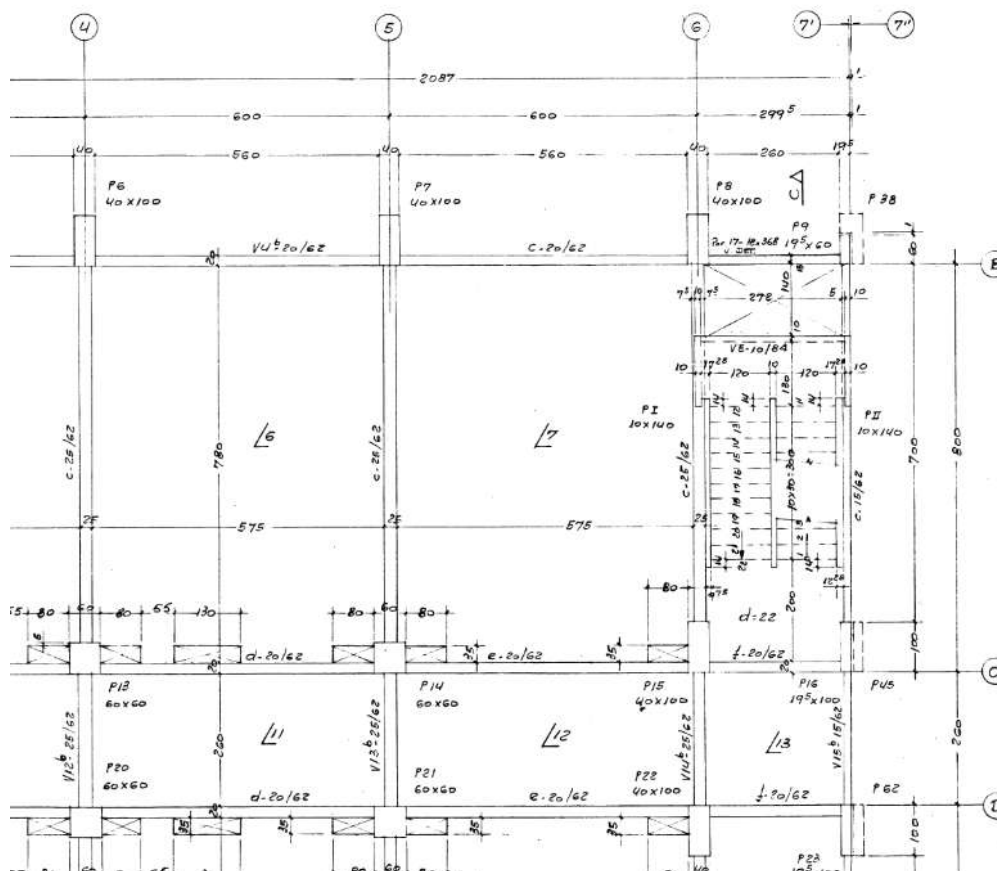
UERJ. Planta de Fôrmas do Teto Tipo Blocos A-A'. Ampliação do trecho de encontro dos pilares com o Bloco B-B' separados pela junta de dilatação de 1cm.
